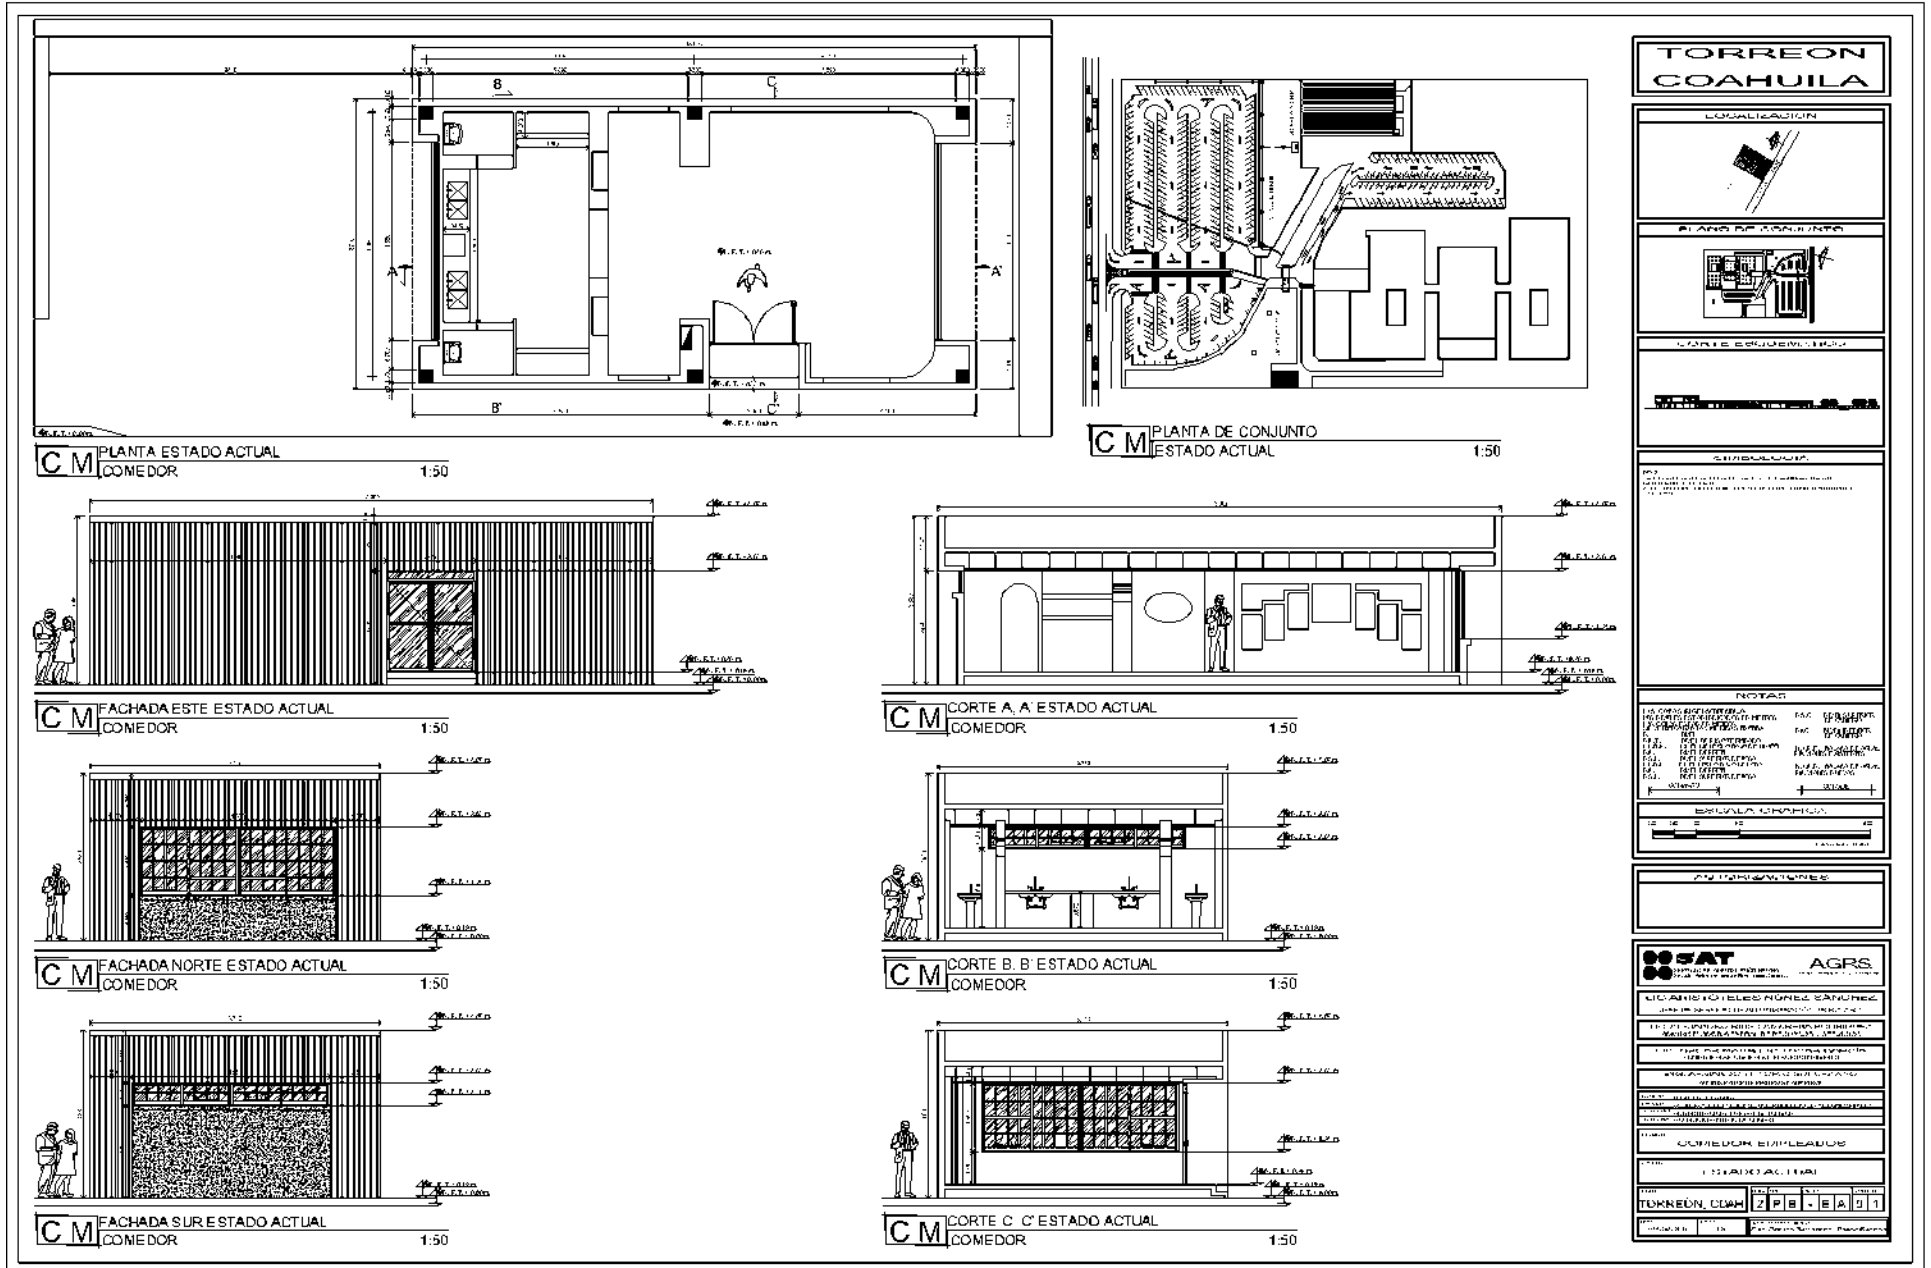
A-PB-EA-04 fachadas edificio A (estado físico de la obra)
